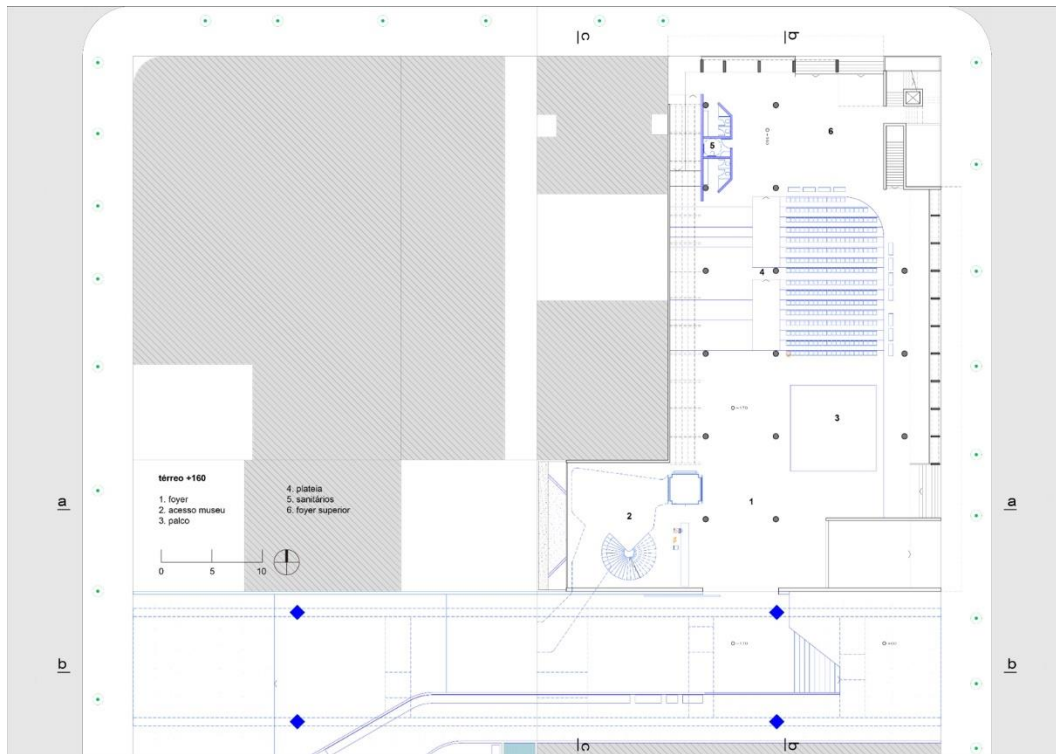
Planta do pavimento térreo da intervenção na agência do Itaú.
